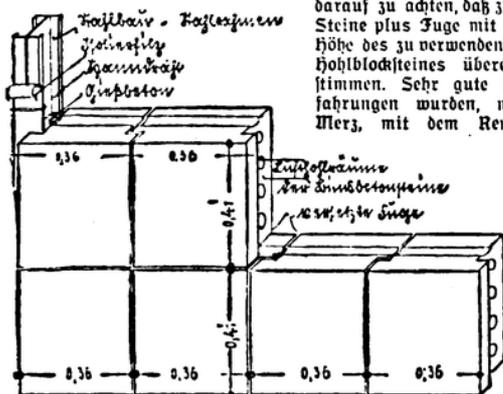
Bimsbetonplattenwand, Steingröße 36 x 41 x 14,5 cm
